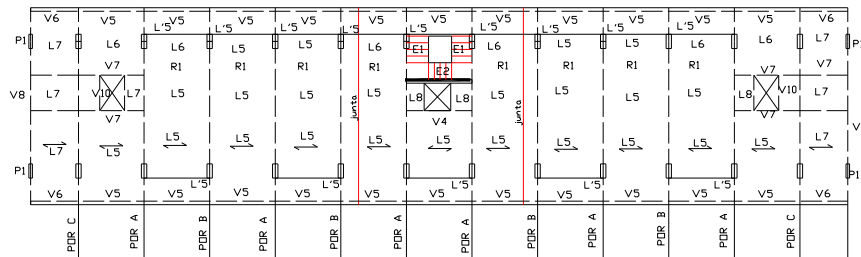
Planta estrutural dos andares inferiores (1º, 3º, 5º e 7º) [40].
